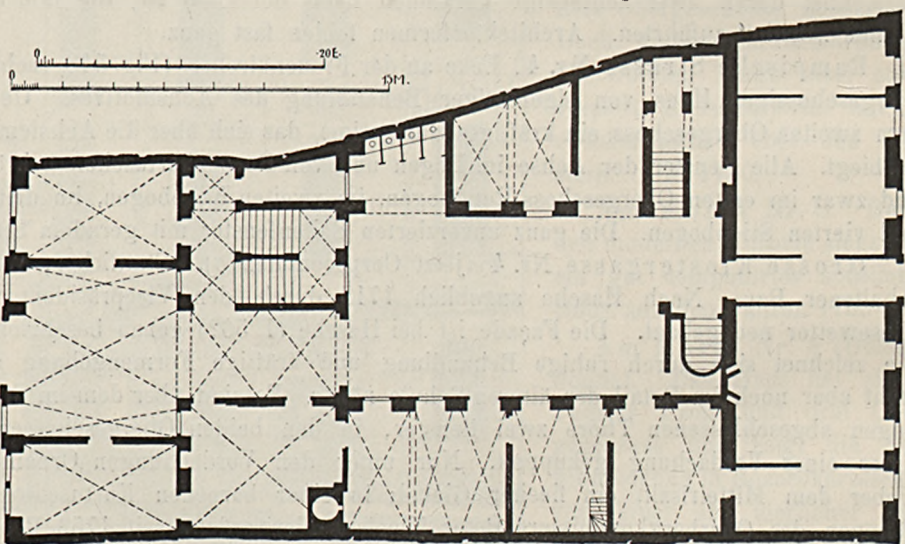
Klostergasse Nr. 4. Grundriss des Erdgeschosses.
